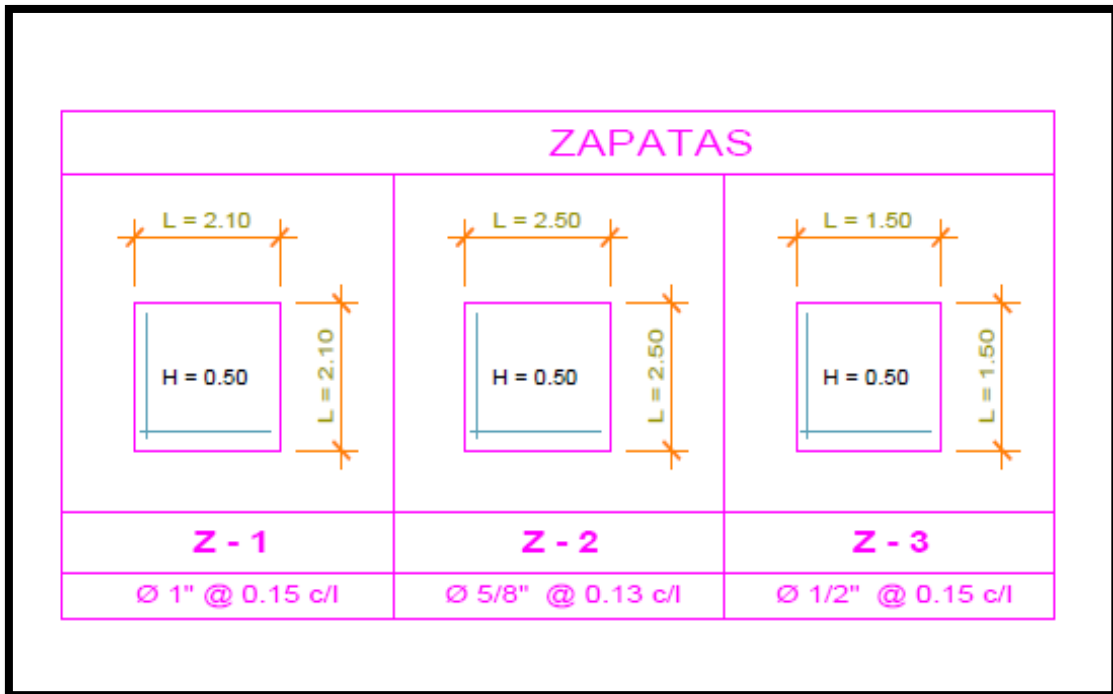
Plano de Estructuras – Planta Cimentación Primer Piso
